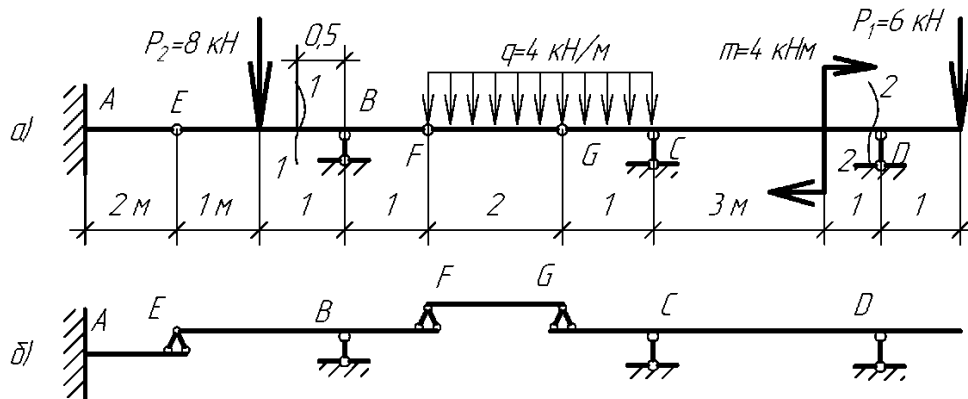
Расчетная схема многопролетной балки и ее «поэтажная» схема
